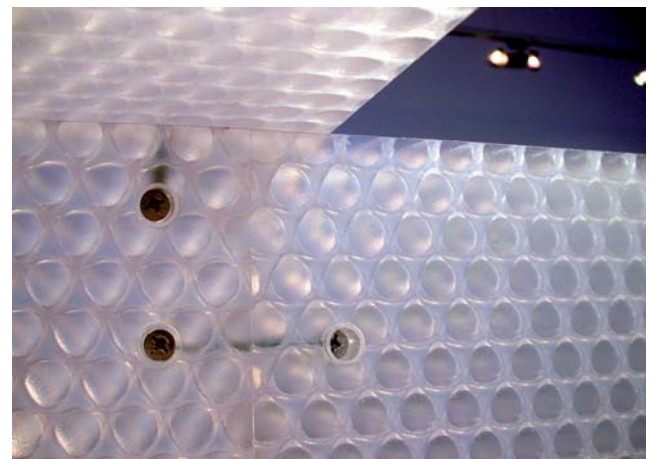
Anschluss-Situationen: Scheibenlängsstoß (unten) und Winkelstoß Decke/Wand (oben)
